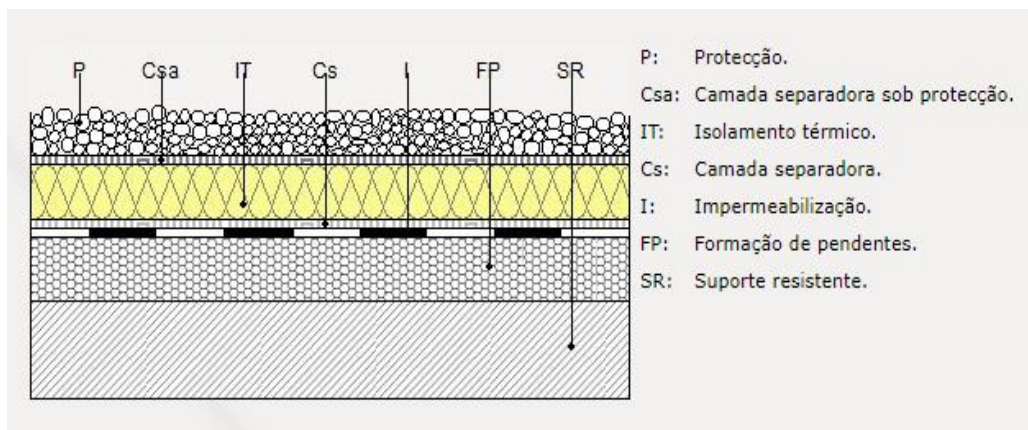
Pormenor construtivo tipo de uma cobertura plana invertida [37]
